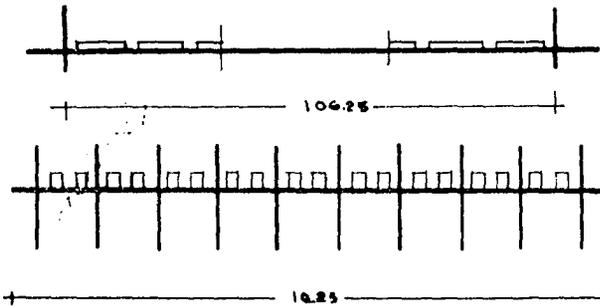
Colocación de los moldes de vigas rectangulares.
